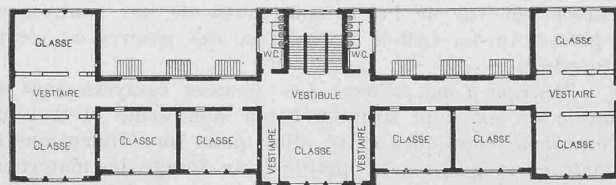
Plan du premier étage. — Echelle 1 : 800.
